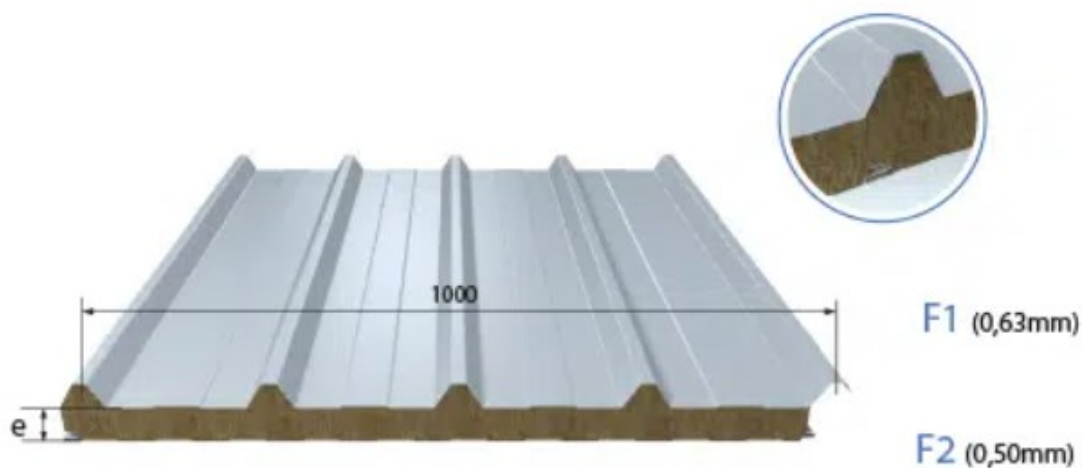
Dimensões do painel sanduíche para cobertura inclinada
